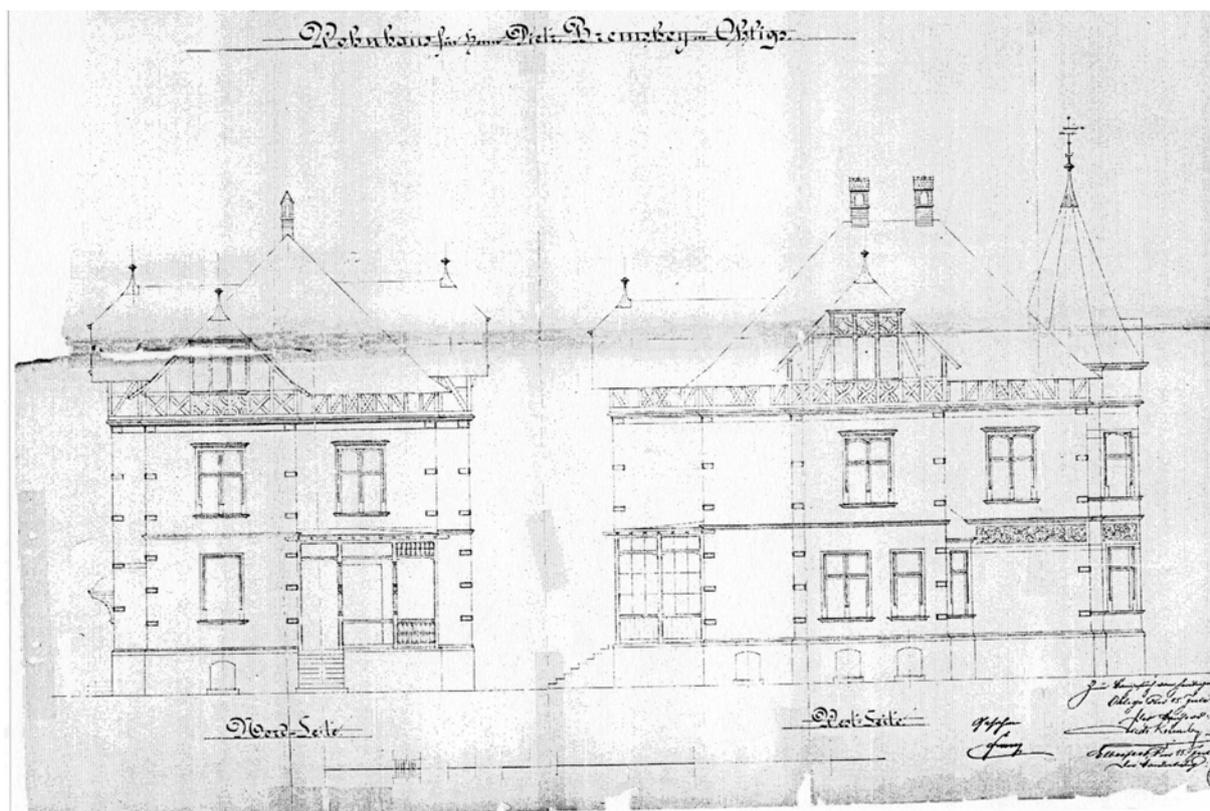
H. Plange, Aufriss Nord- und Westfassade, 1896
